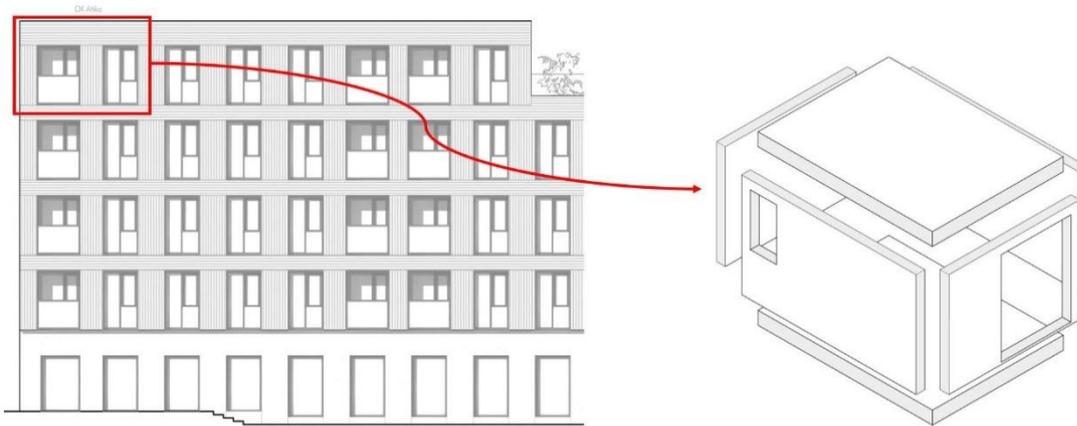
Planungsprozess für einen Teilausschnitt eines mehrgeschossigen Holzbaus
